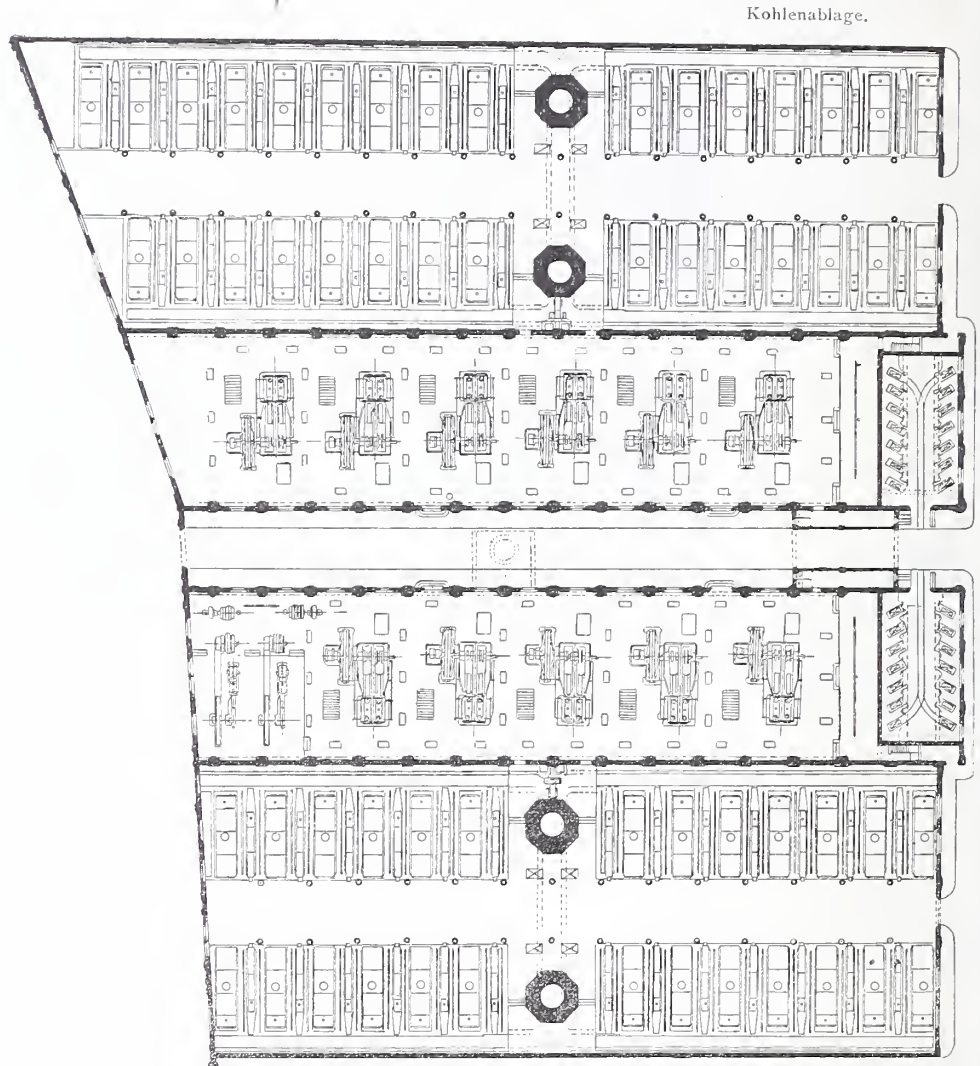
Grundriss der Dampfcentrale von Porta Volta in Mailand 1:800.
